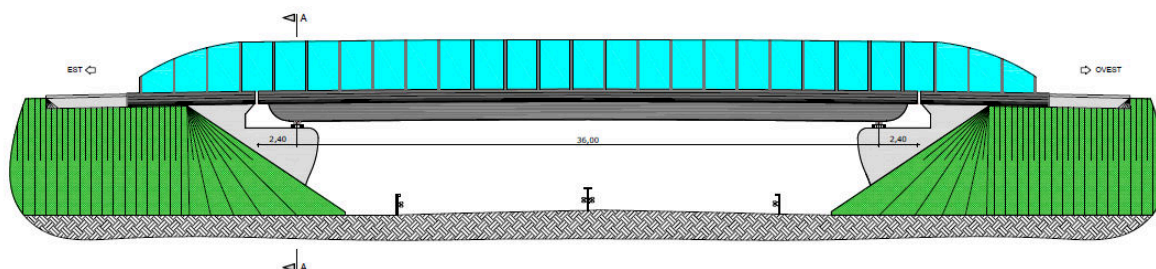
Prospetto nuovo sovrappasso (Fonte: Allegato 1 Tavola 14)
